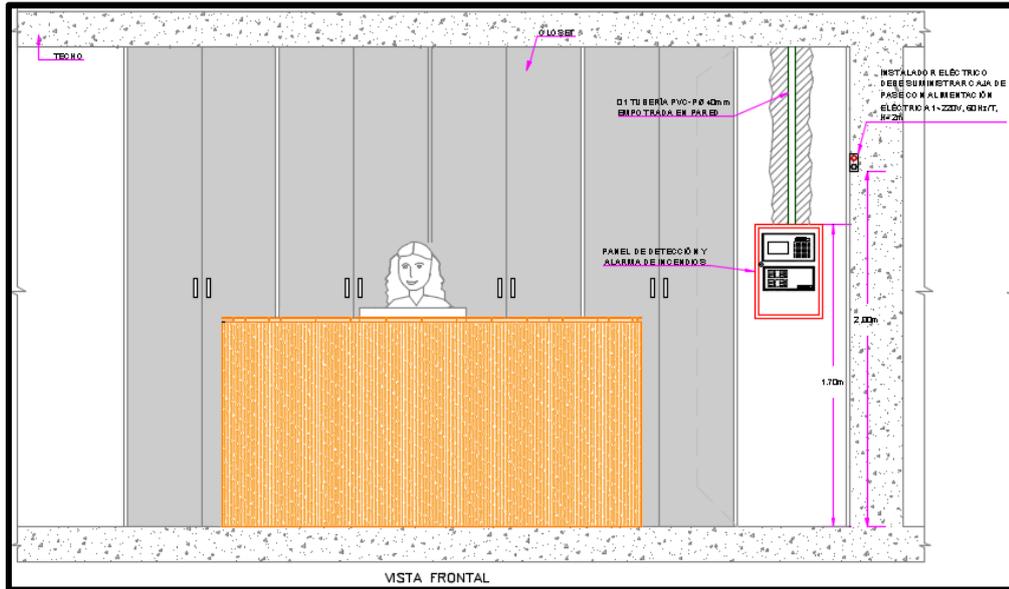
Ubicación de FACP en Closet, Plano de Detalles (Vista Frontal)
